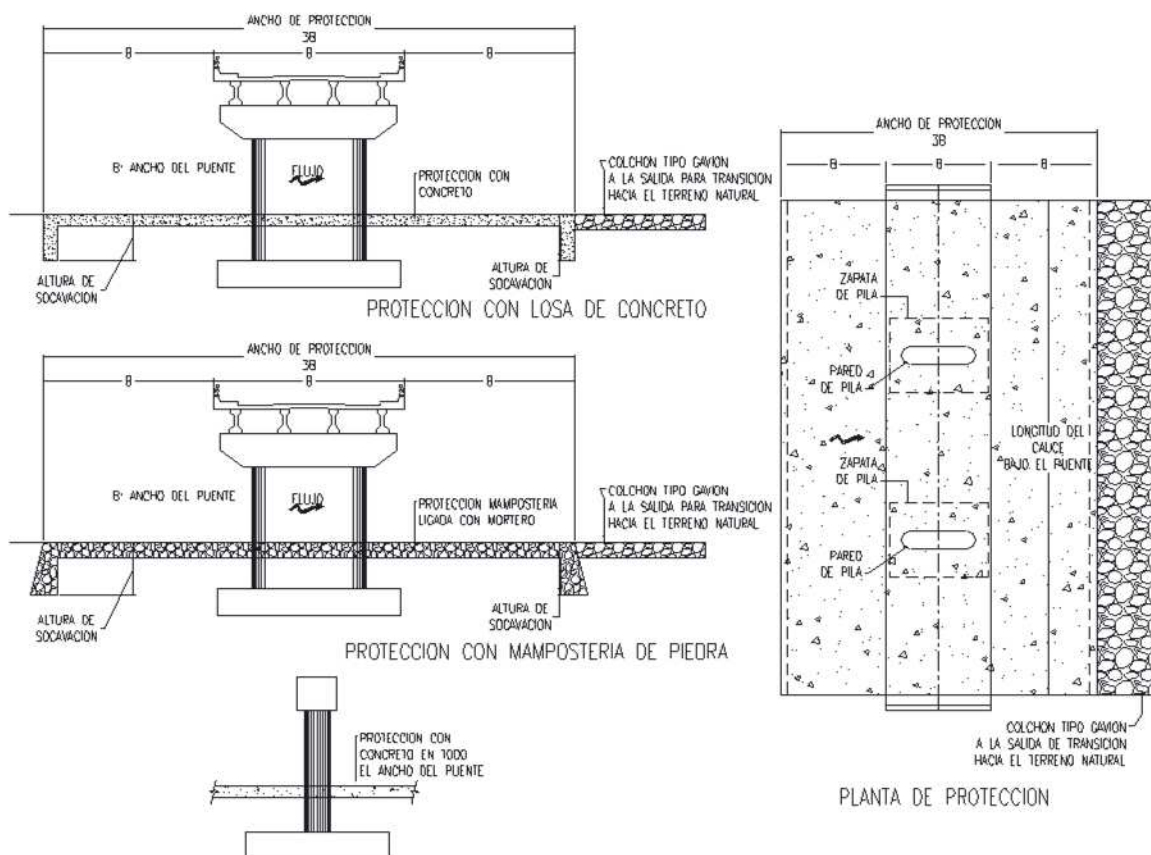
Tipo de protección en pilas, en todo el ancho del cauce. (SPOP, 2014)
